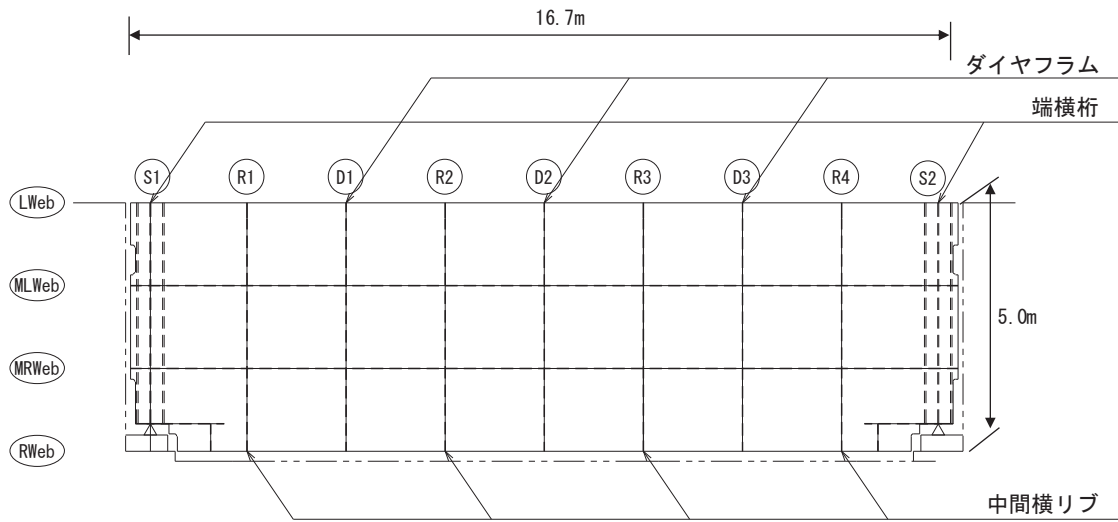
(2) 鋼製遮水壁 (鋼桁 2) 平面図
